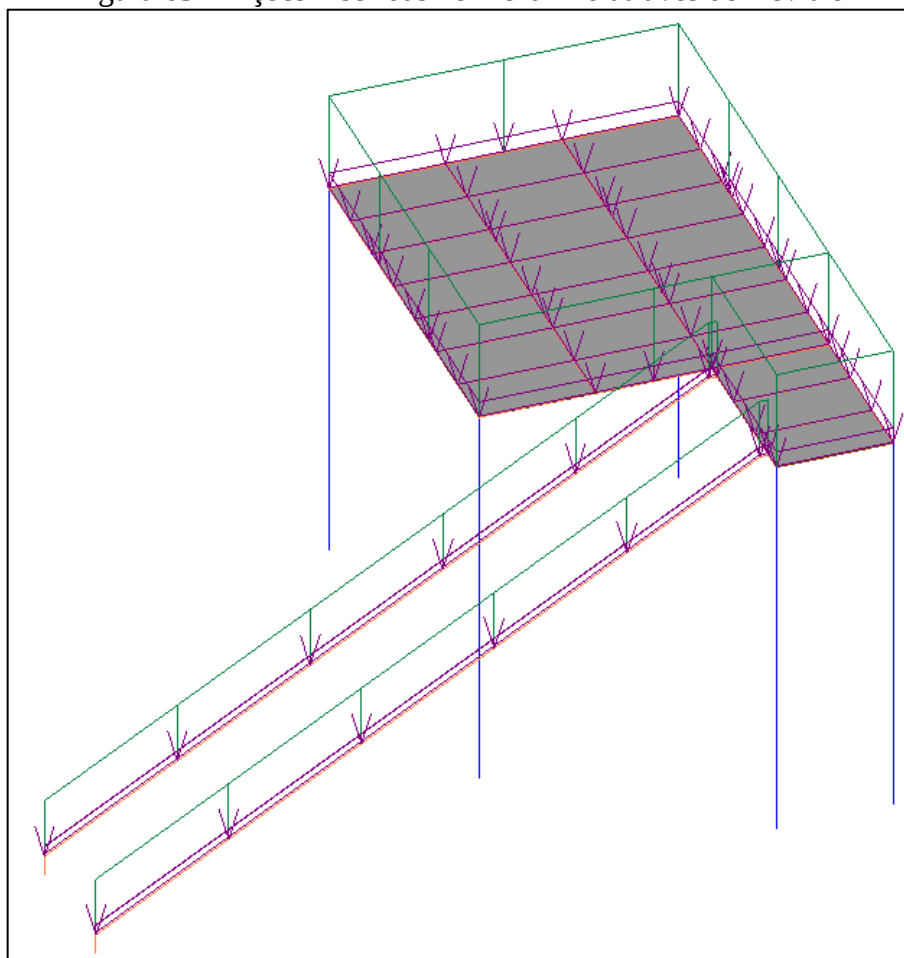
Ações nas vigas da escada aplicadas no Revit ®
